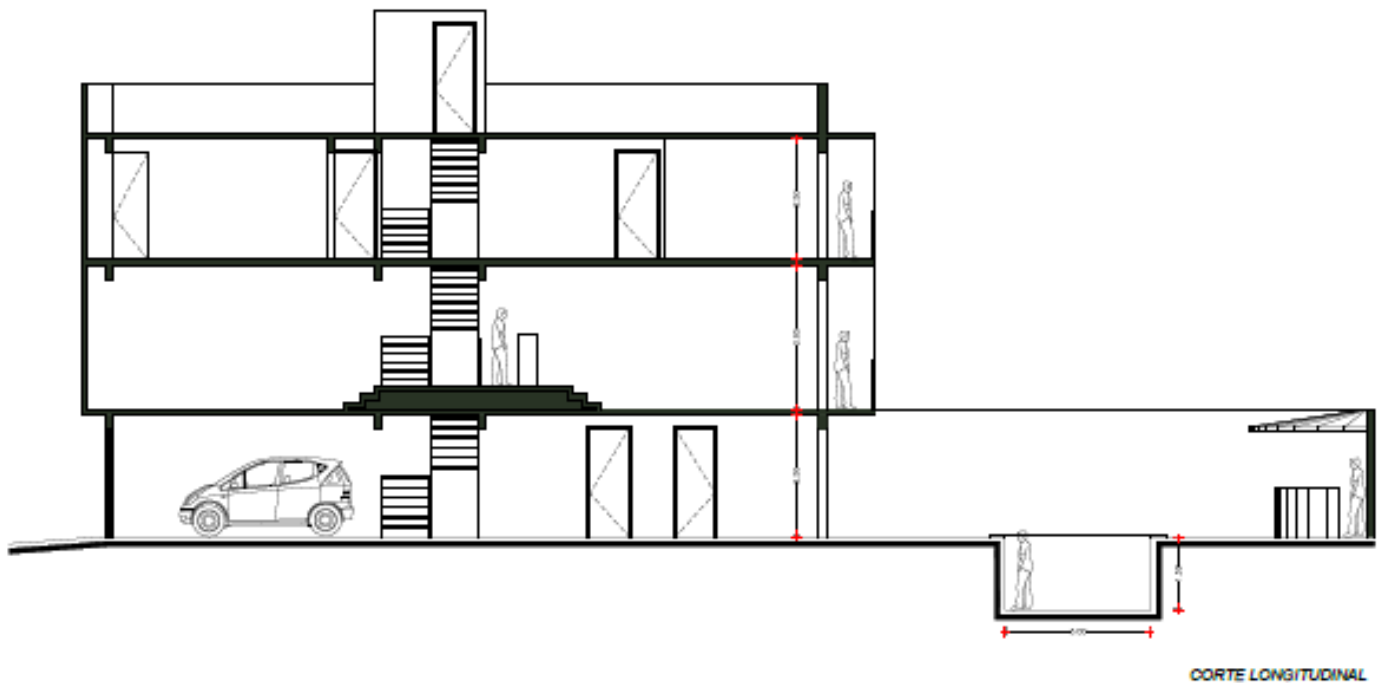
Corte longitudinal de proyecto, Autoría propia.
